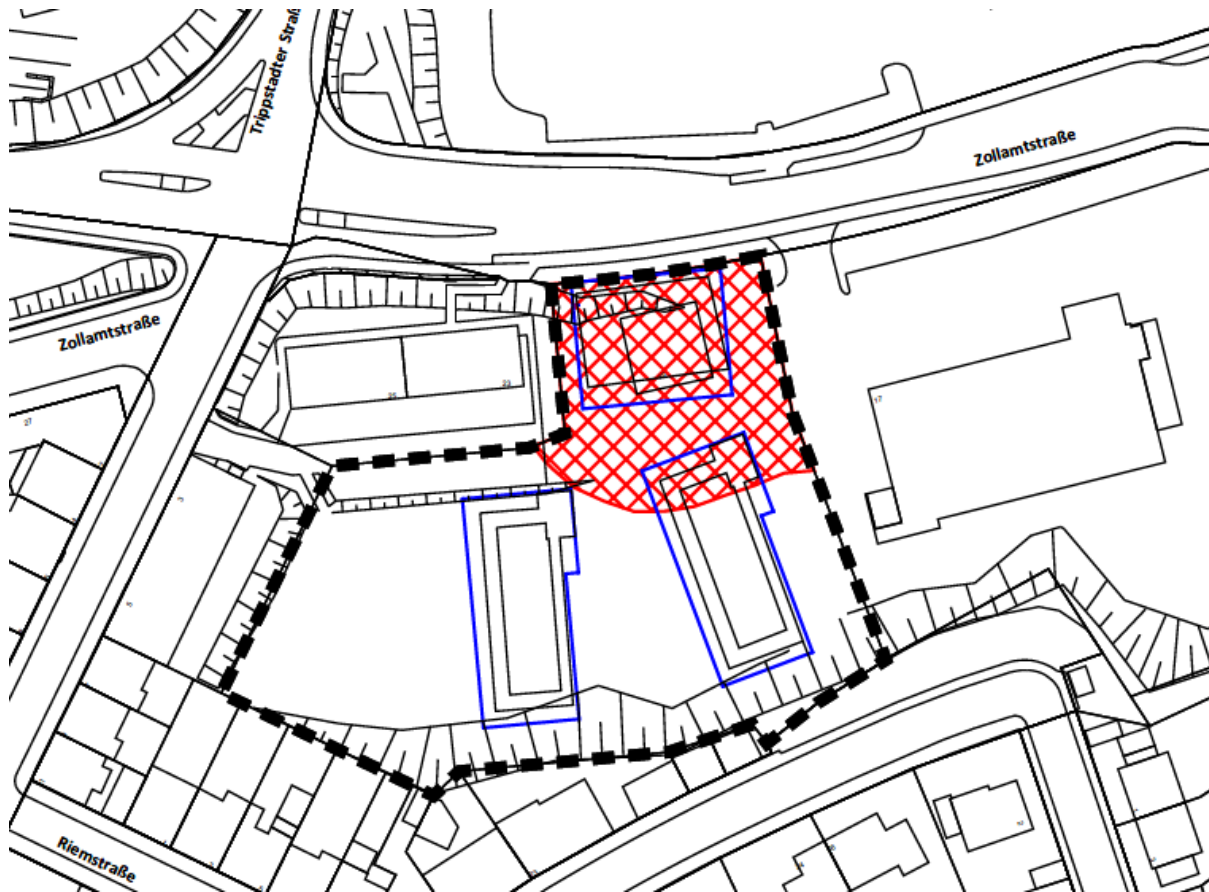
Flächen mit Vorgaben zur Grundrissorientierung
